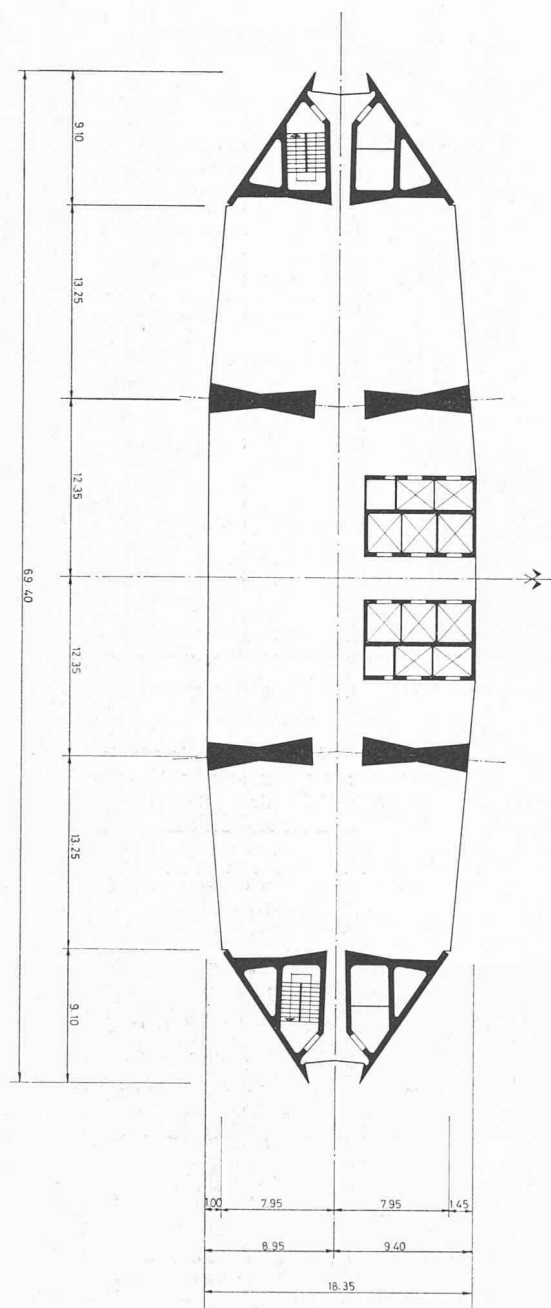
Tour Pirelli, Milan 1956. Vue en plan. Structure avec noyaux d'extrémité et parois intérieures.
